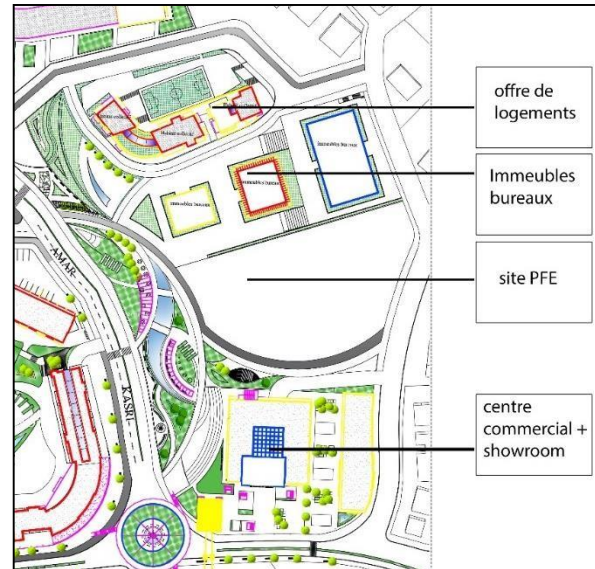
Vue en plan des propositions d'aménagement de site MOKADEM
